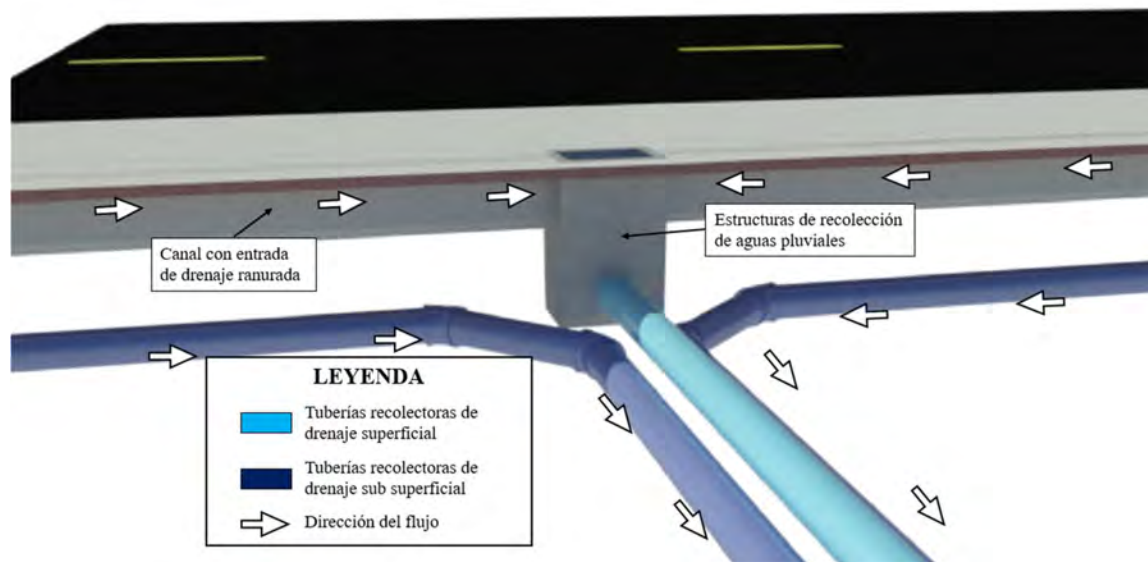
Planteamiento de drenaje pluvial y subsuperficial
